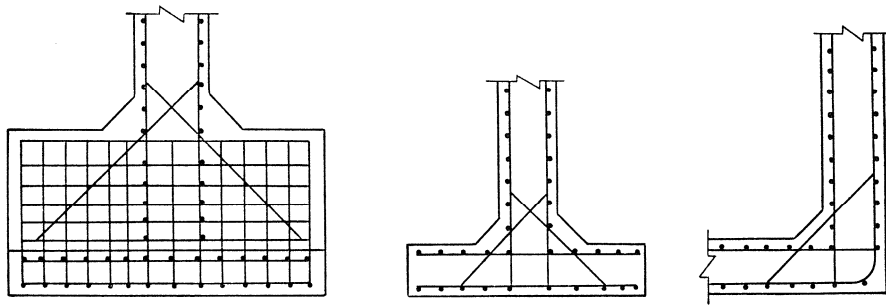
門柱と堰柱との結合部、堰柱と床版との結合部の配筋
